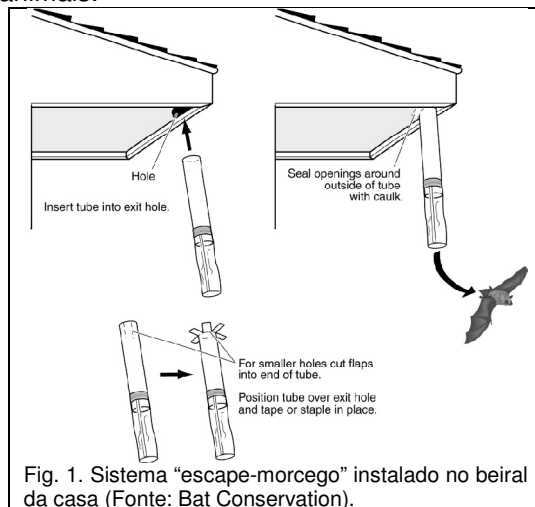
Sistema "escape-morcego" instalado no beiral da casa (Fonte: Bat Conservation).
